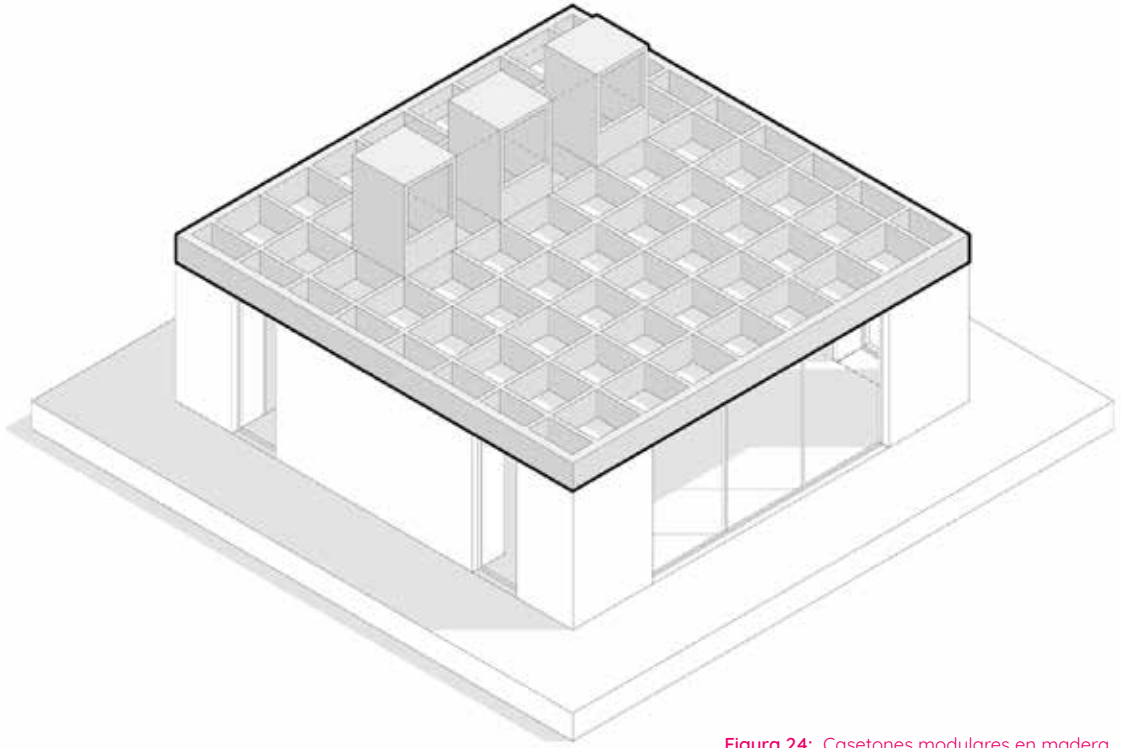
Casetones modulares en madera laminada configuran el techo. Proyecto Future Edu Space
